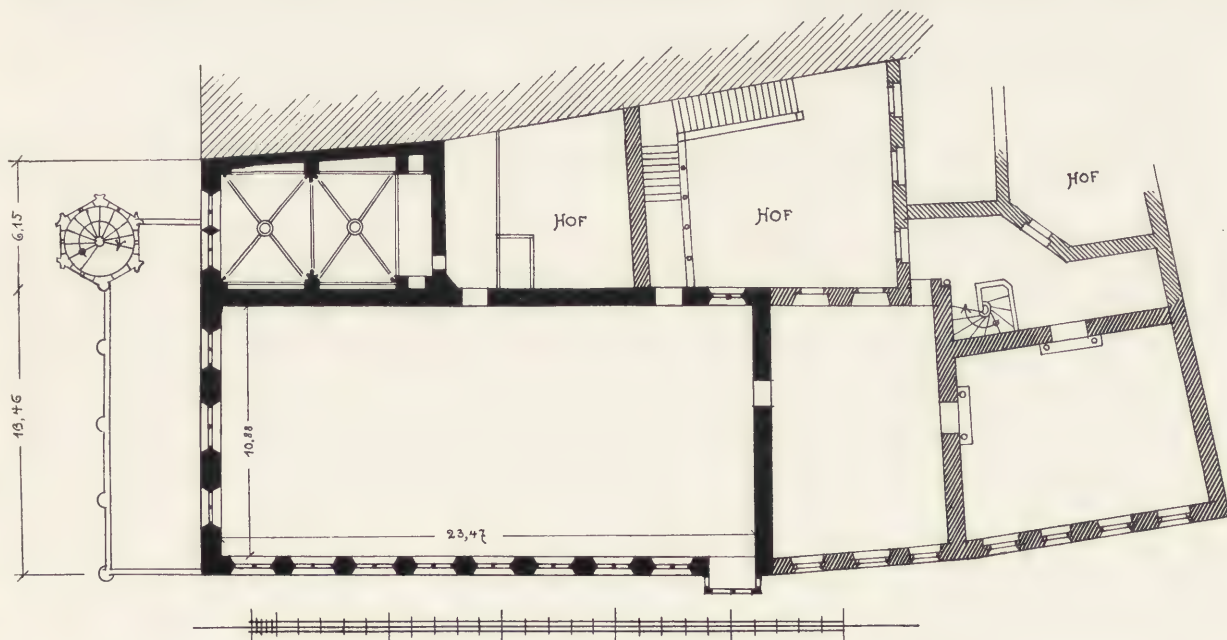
Rathaus zu Amberg. Grundriß des ersten Stockwerks.
